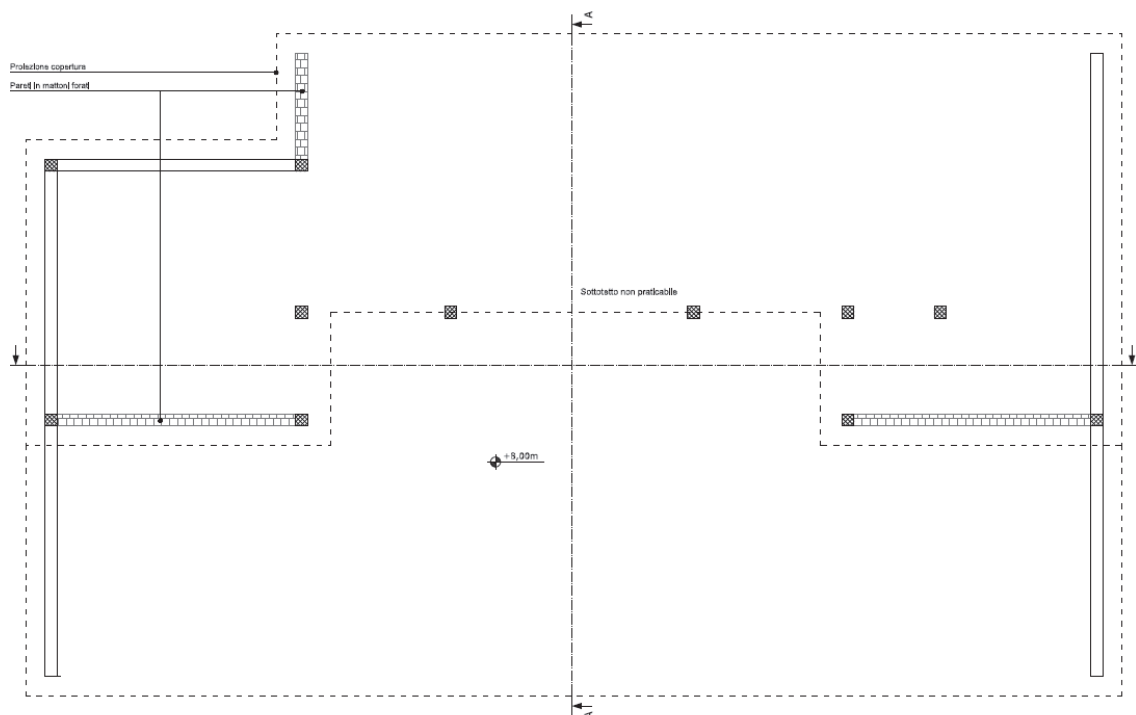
Pianta Piano Sottotetto dell'Edificio
